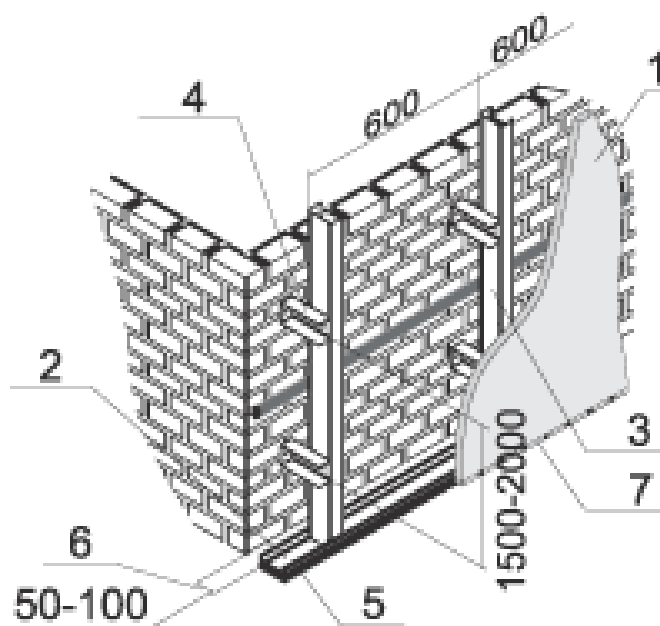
Облицовка кирпичных, бетонных или иных стен гипсокартонными листами (ГКЛ) по металлическим профилям
